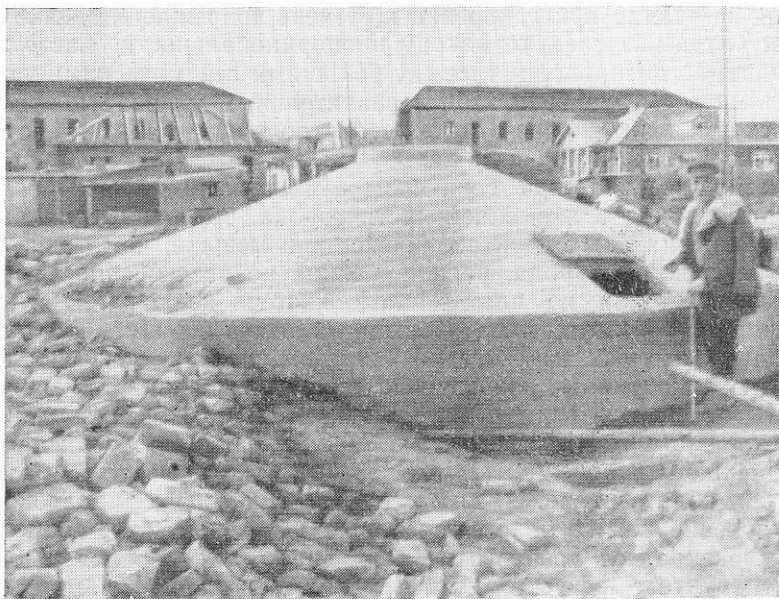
Хорошо сохранившийся подземный железобетонный резервуар
